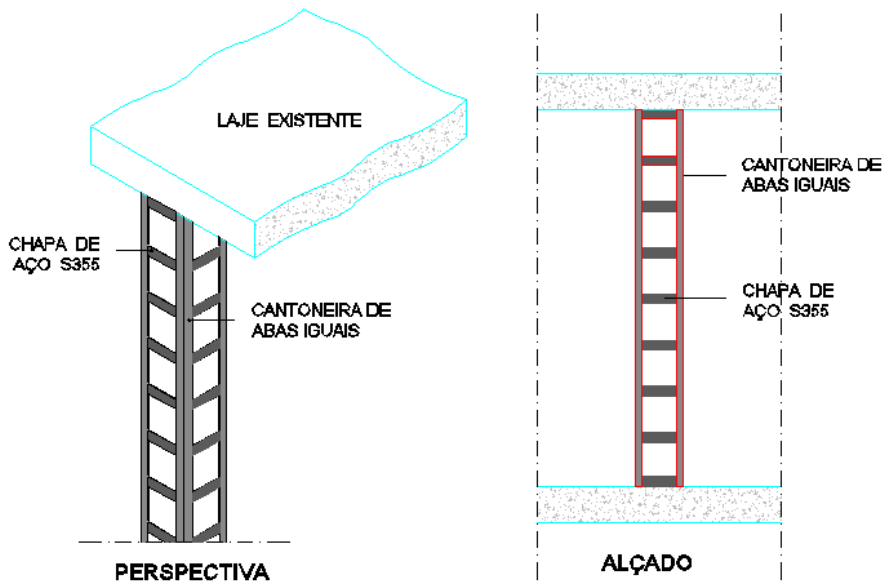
Reforço de pilares com cantoneiras e chapas metálicas (hipótese adoptada) [42]
